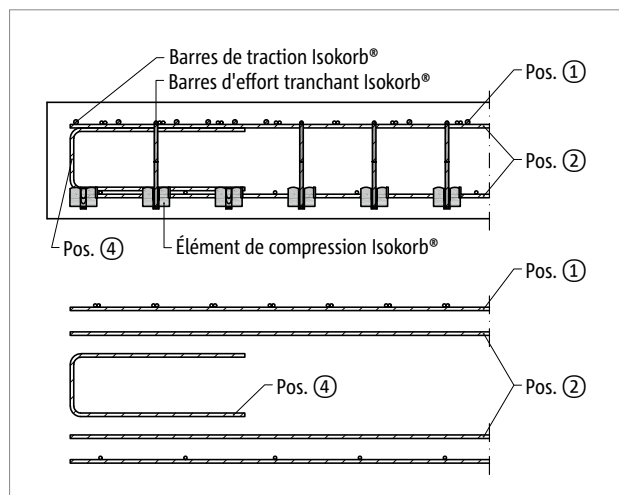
Schöck Isokorb® T Type K-E, K-T : Renforcement sur site du côté balcon pour la coupe AA ; Pos.4 = bordure constructive sur bord libre perpendiculaire à l'élément Schöck Isokorb®
